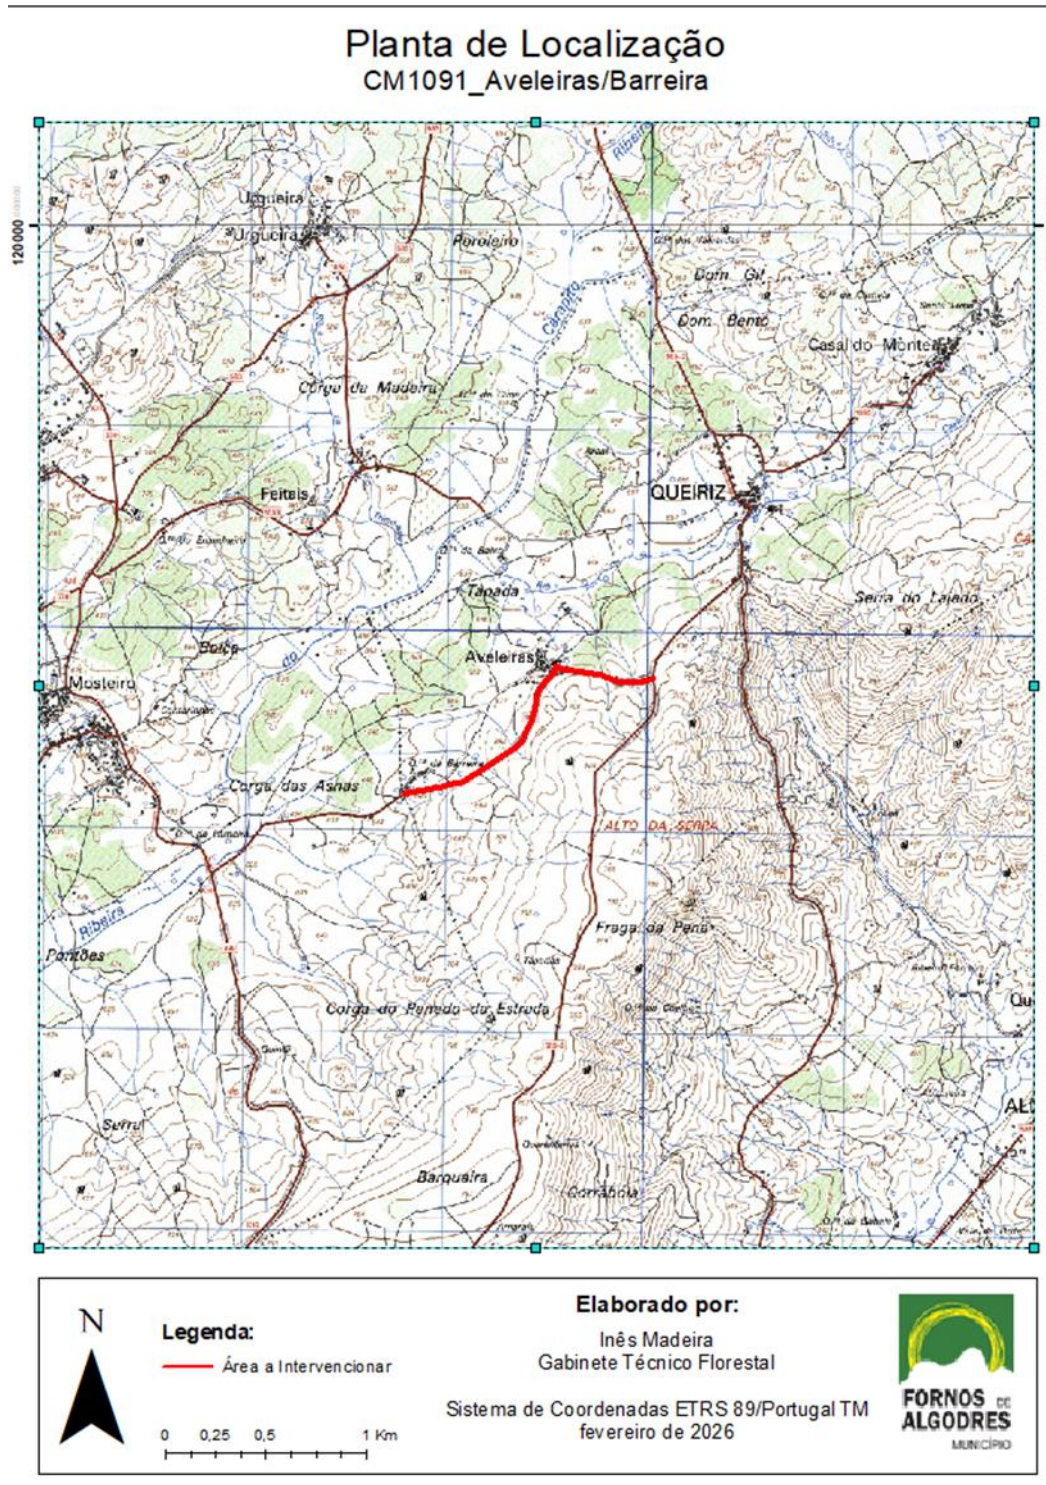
Planta de localização CM1091_Aveleiras/Barreira
